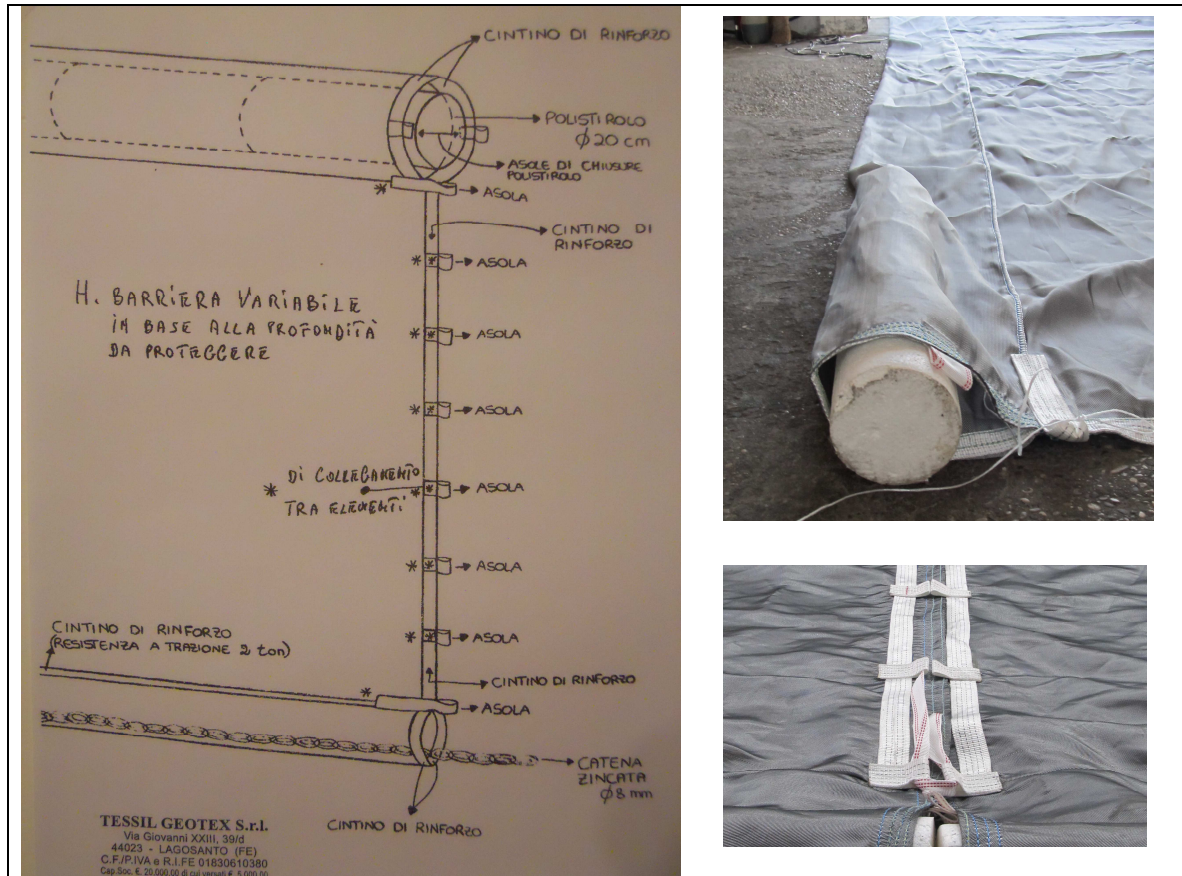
Tipo e caratteristiche delle barriere galleggianti in dotazione al cantiere
